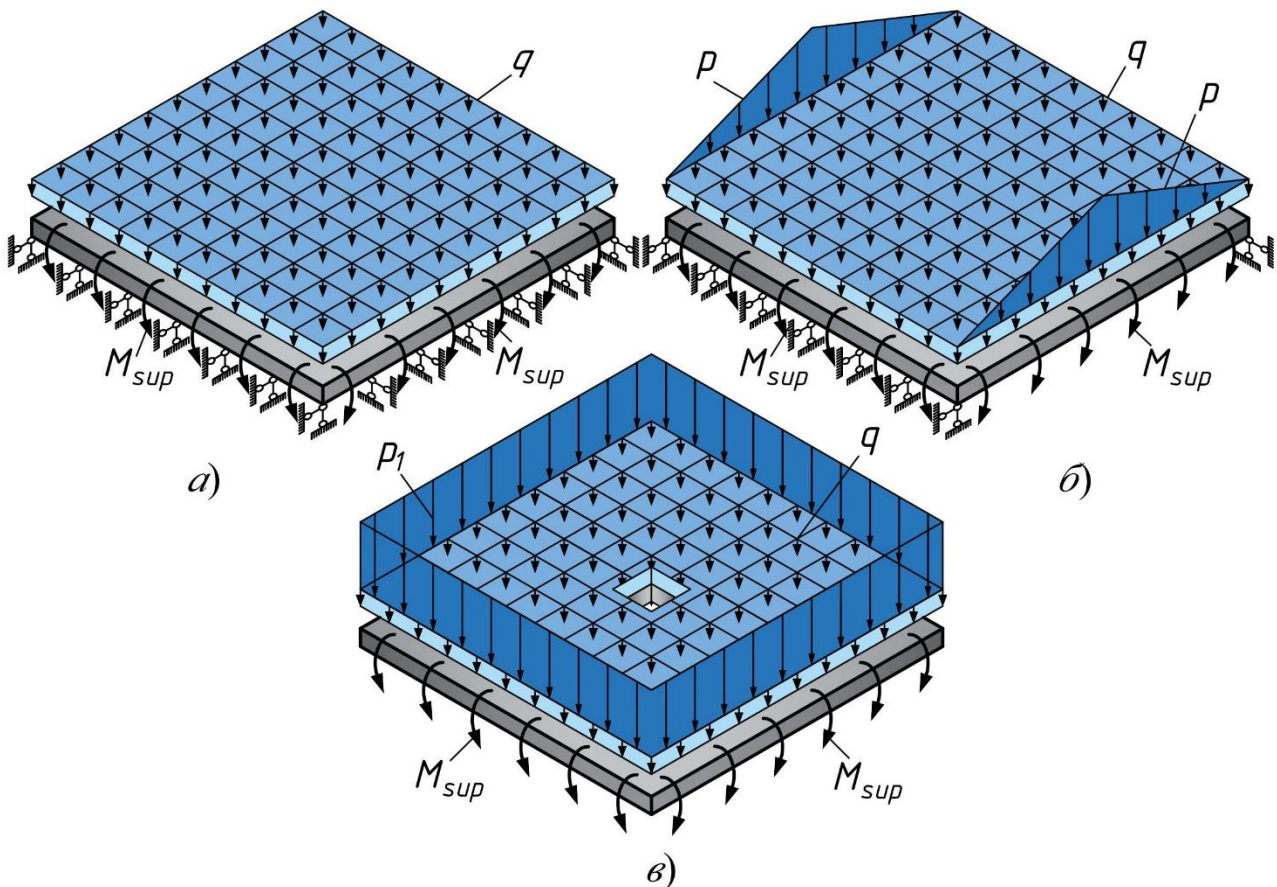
Розрахункові схеми спирання та завантаження збірних плит безкапітельно-безбалкового перекриття: а) – середньої; б) – міжколонної; в) – надколонної; q – загальне (постійне і змінне) навантаження на перекриття; p – навантаження від реакції опор середніх плит; p_1 – навантаження від реакції опор міжколонних плит; M_{sup} – згинальний момент, який сприймається петлевим стиком
